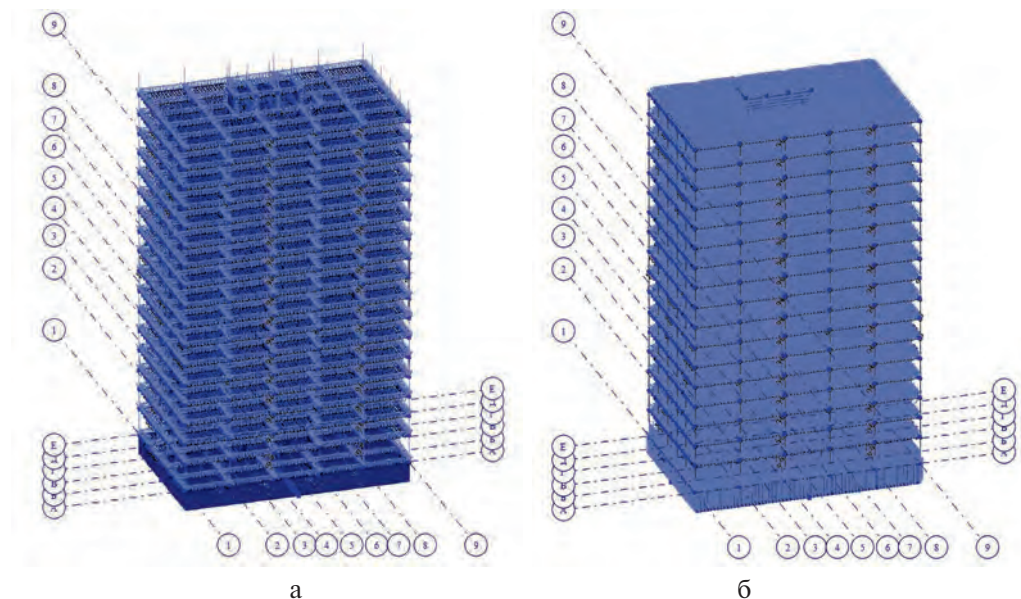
Собственный вес металлических (а) и железобетонных (б) конструкций
